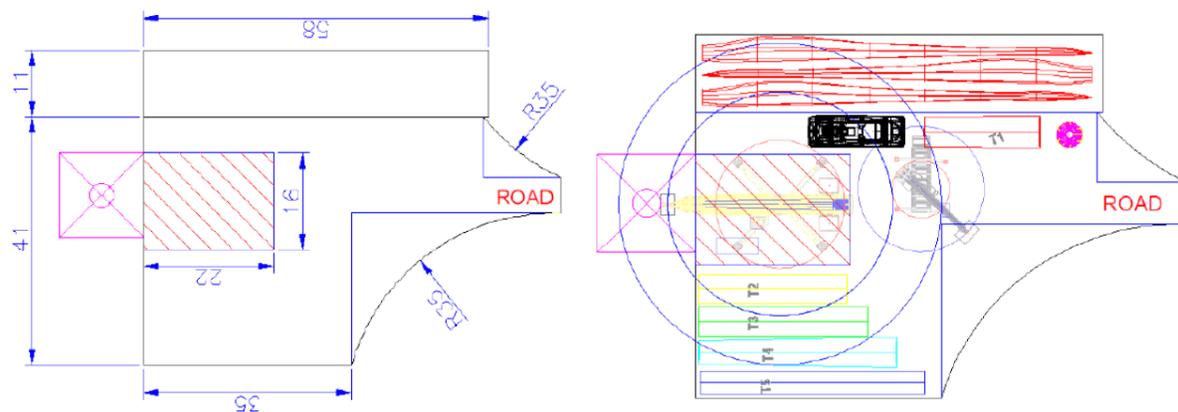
Plan de masse d'une plateforme de montage-type (Source : VALECO)
